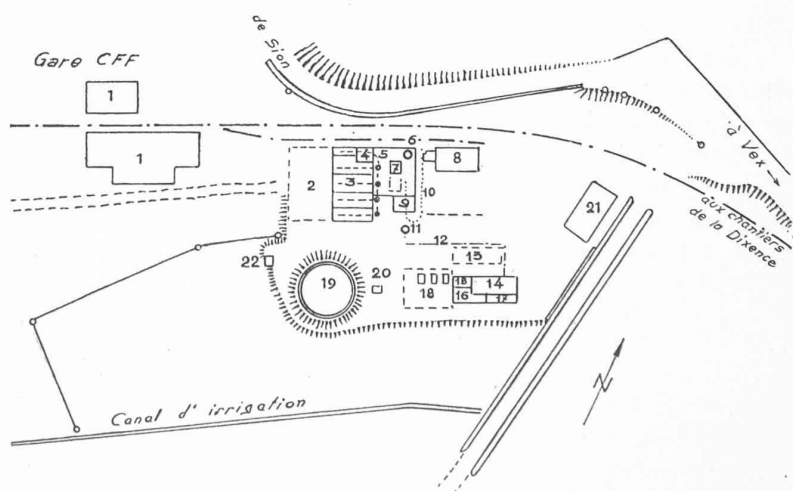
Plan de situation. — Echelle 1 : 2500.
